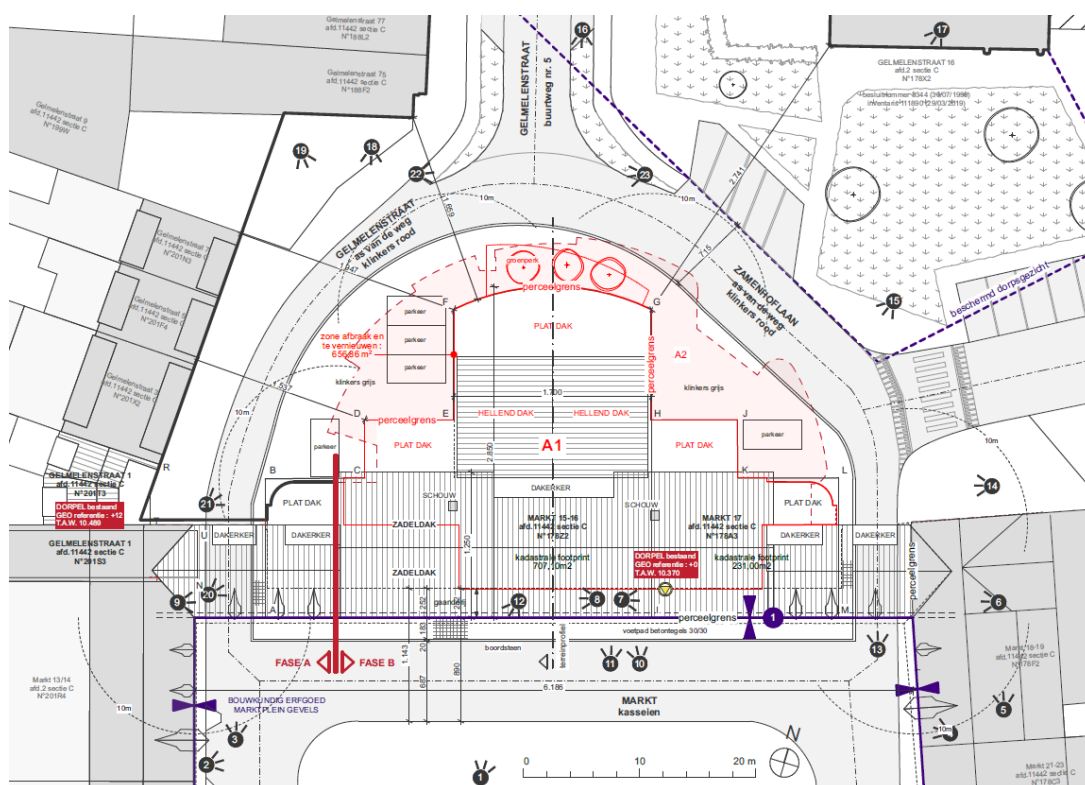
Plan renovatie en uitbreiding Gelmelenhof, vergunning 14/08/20 (bron: gemeente Schoten).
